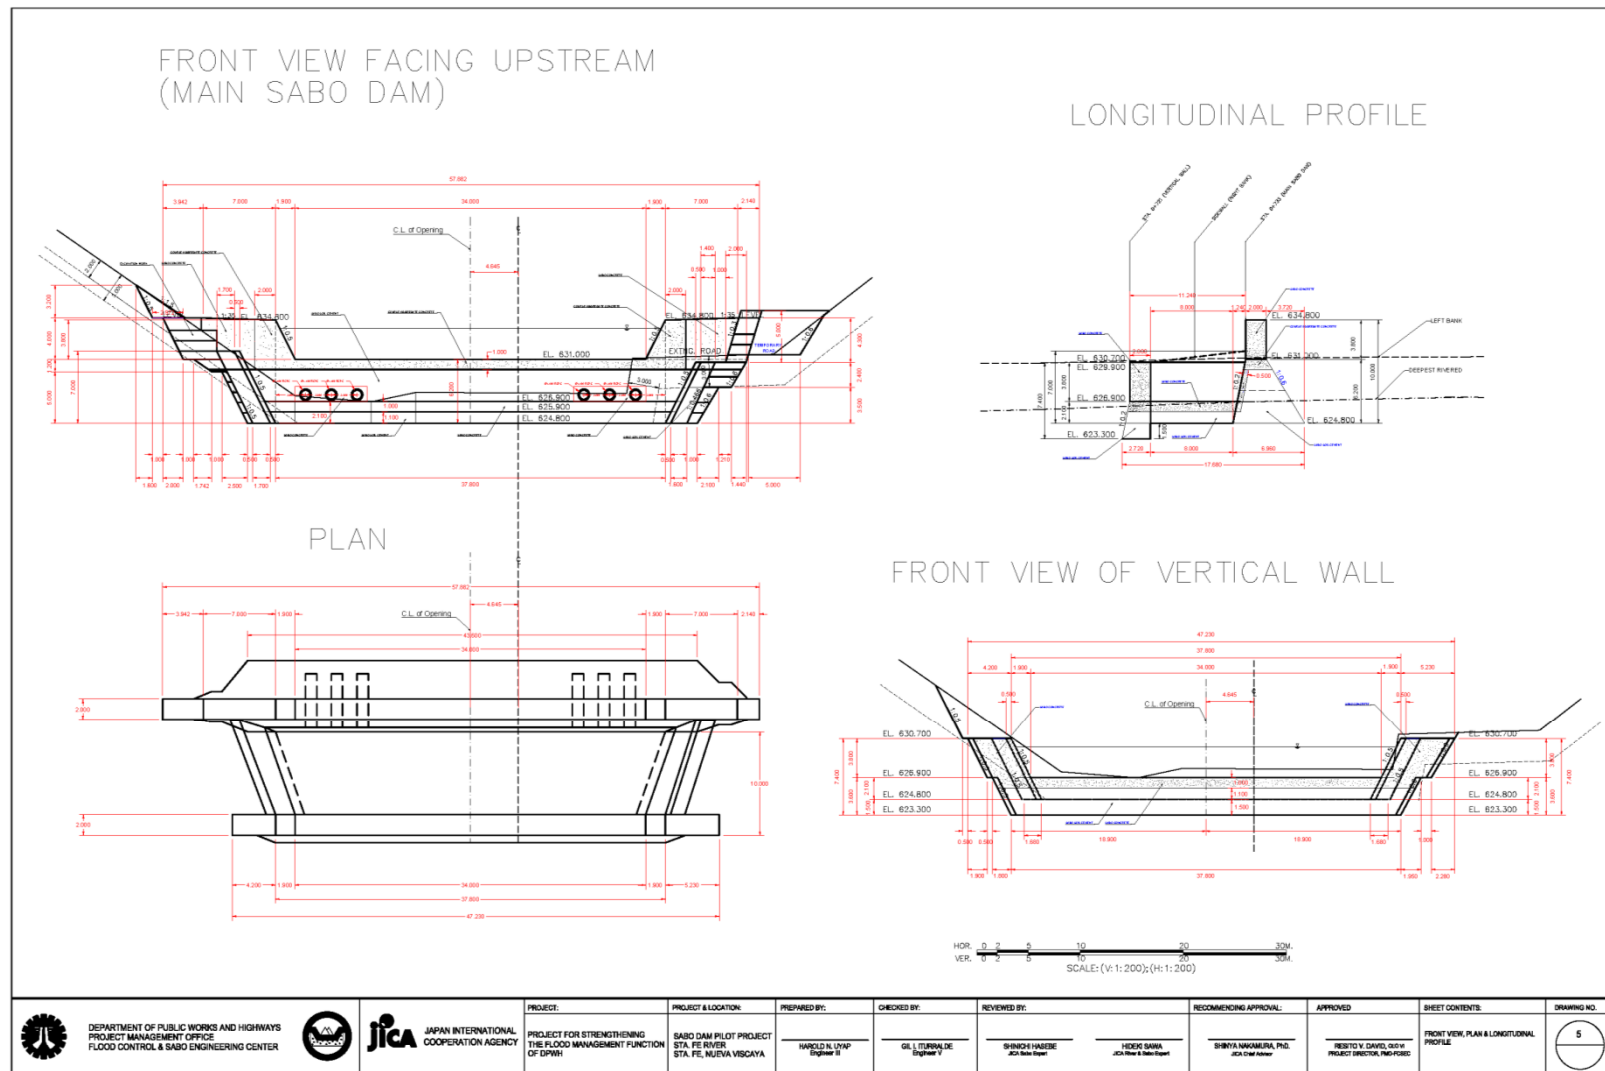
サンタフェ砂防堰堤下流面図・平面図・縦断面図
